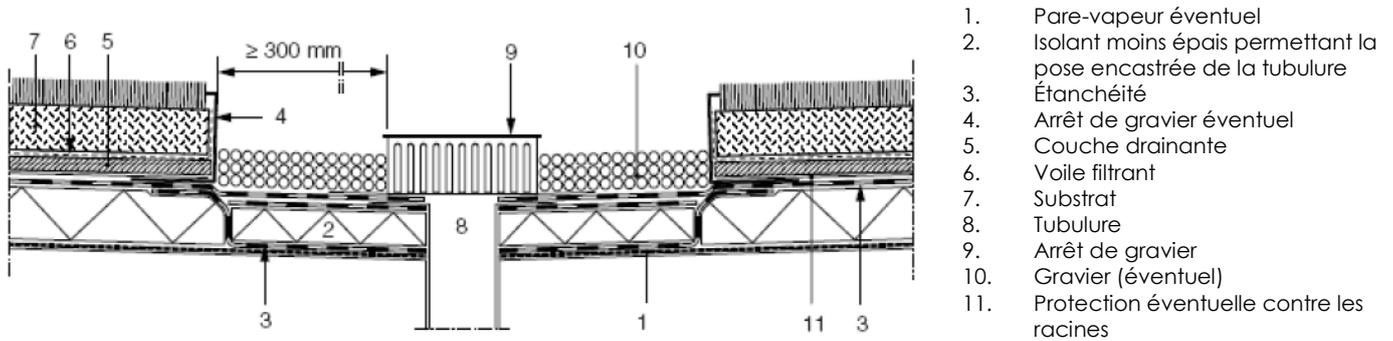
Détails de toiture : Tubulure accessible d'une toiture végétalisée
